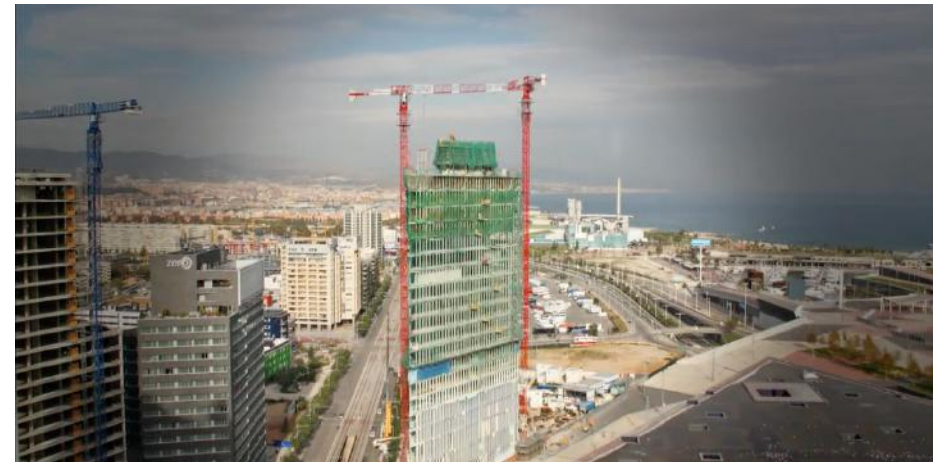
Montaje soportes y ejecución del núcleo central de hormigón
